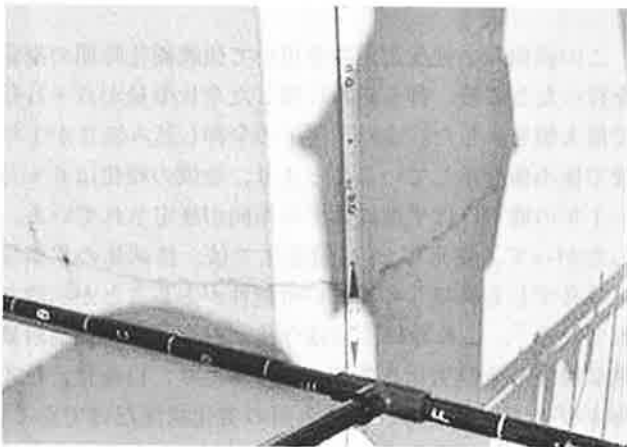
橋脚打ち継部のひび割れ状況の一例
